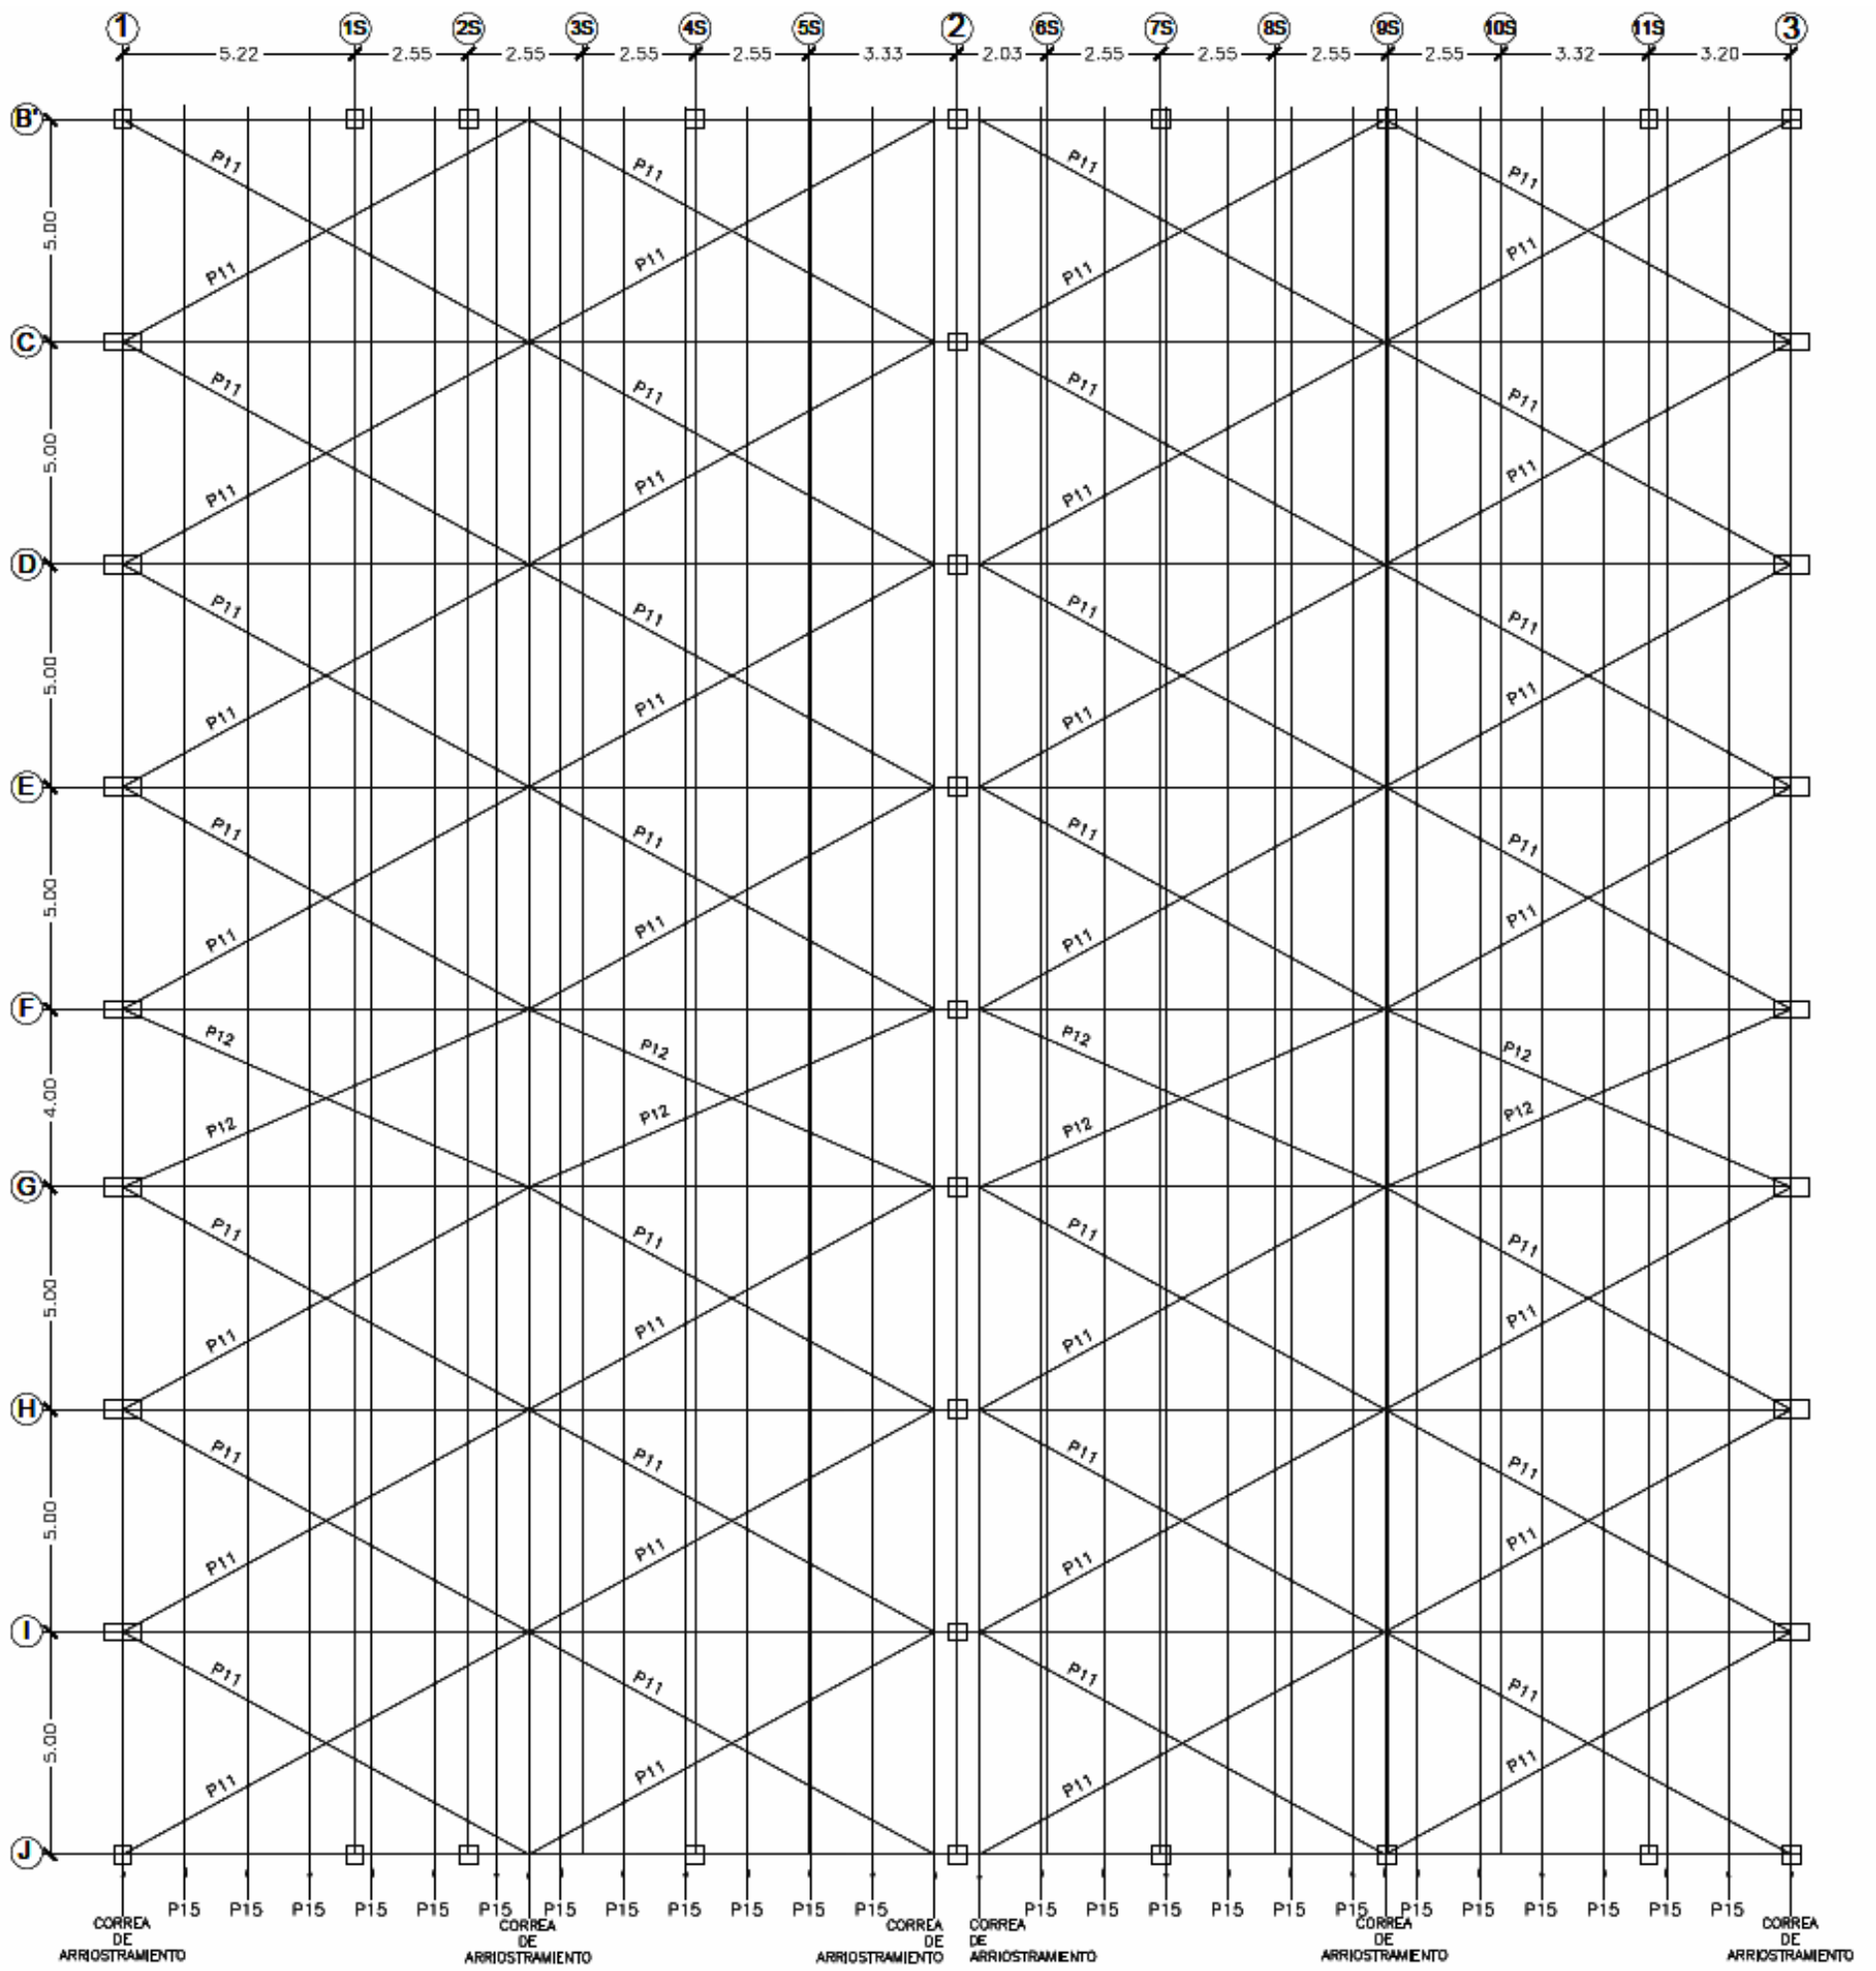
Vista en planta de la cubierta metálica del mercado de Guayaquil
